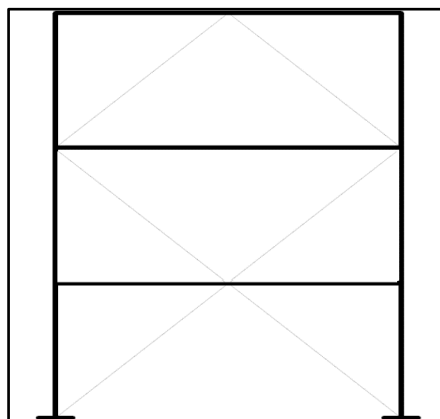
Sistema arriostrado concéntricamente multinivel, diagonales en pares opuestos.
